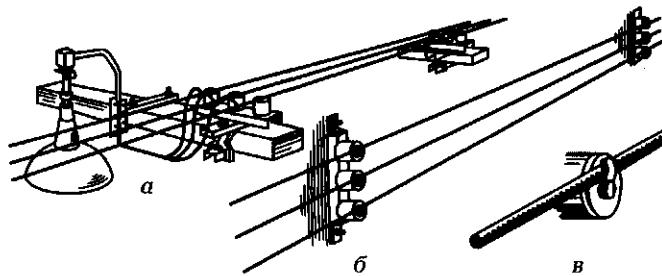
Примеры выполнения электропроводки на изоляторах:
